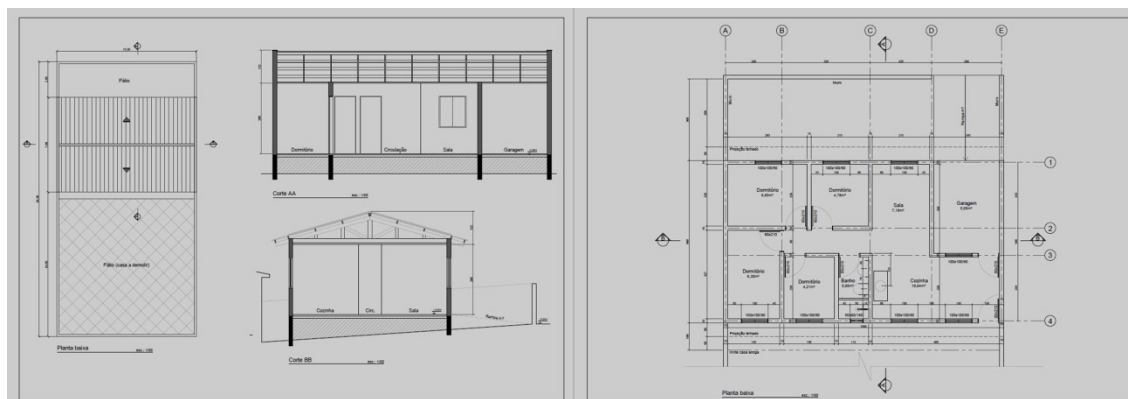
Implantação, cortes e planta baixa do projeto desenvolvido. Fonte: ASCPOA.
